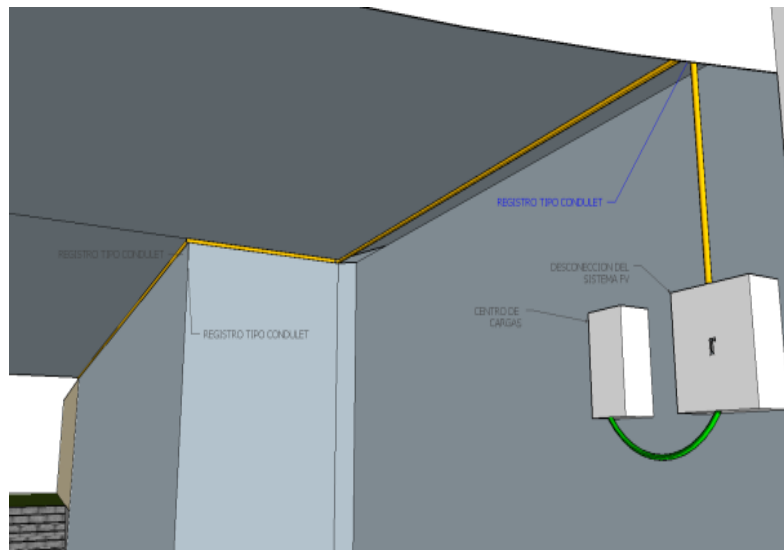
Plano 3D de ruta de tubería, vista 7: aporte propio.
